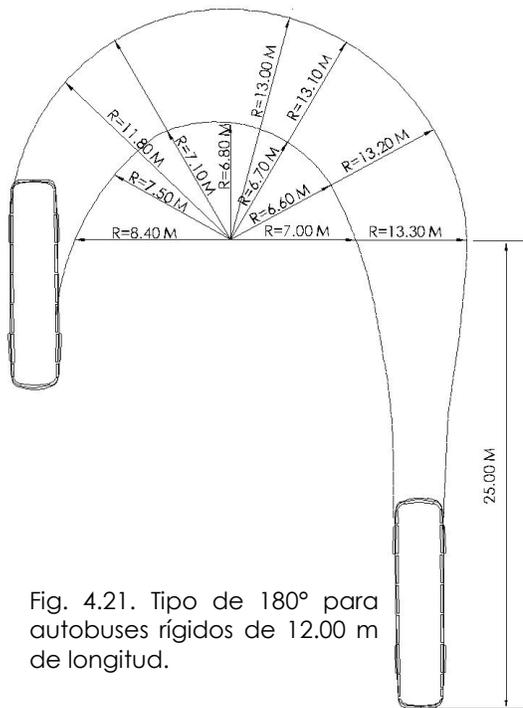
Tipo de 180° para autobuses rígidos de 12.00 m de longitud.
